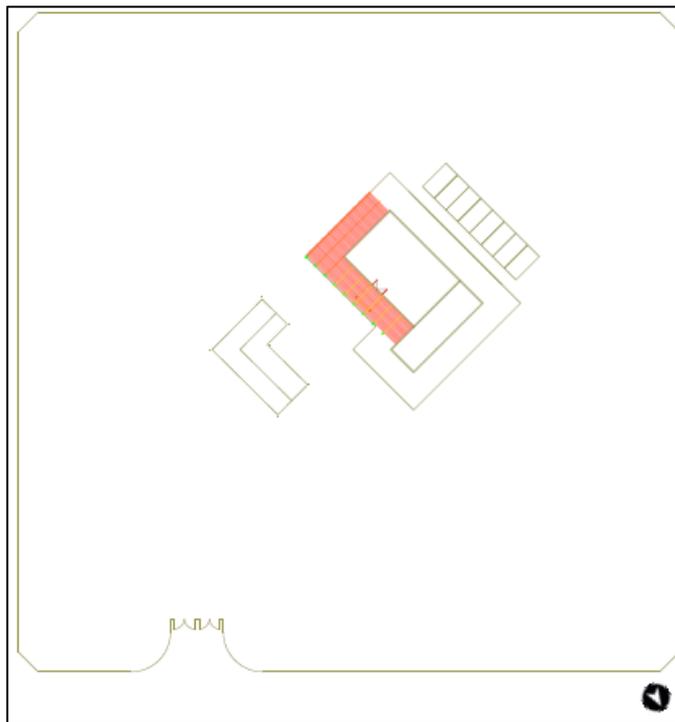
Plano de relevamiento de la propiedad (no a escala).
